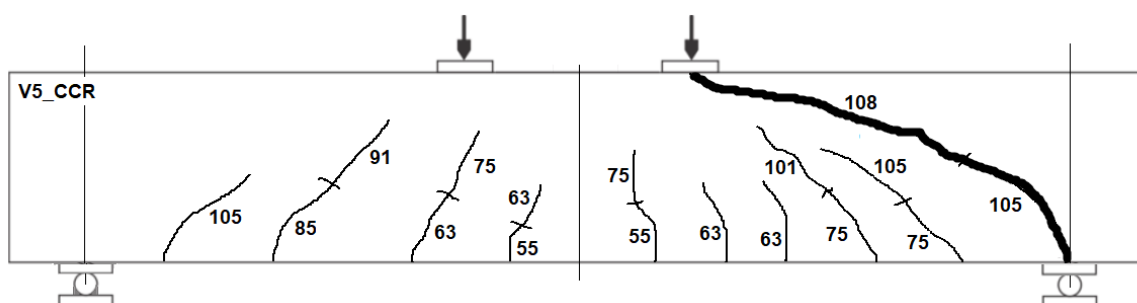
Esquema de fissuração da Viga 5_CCR.
